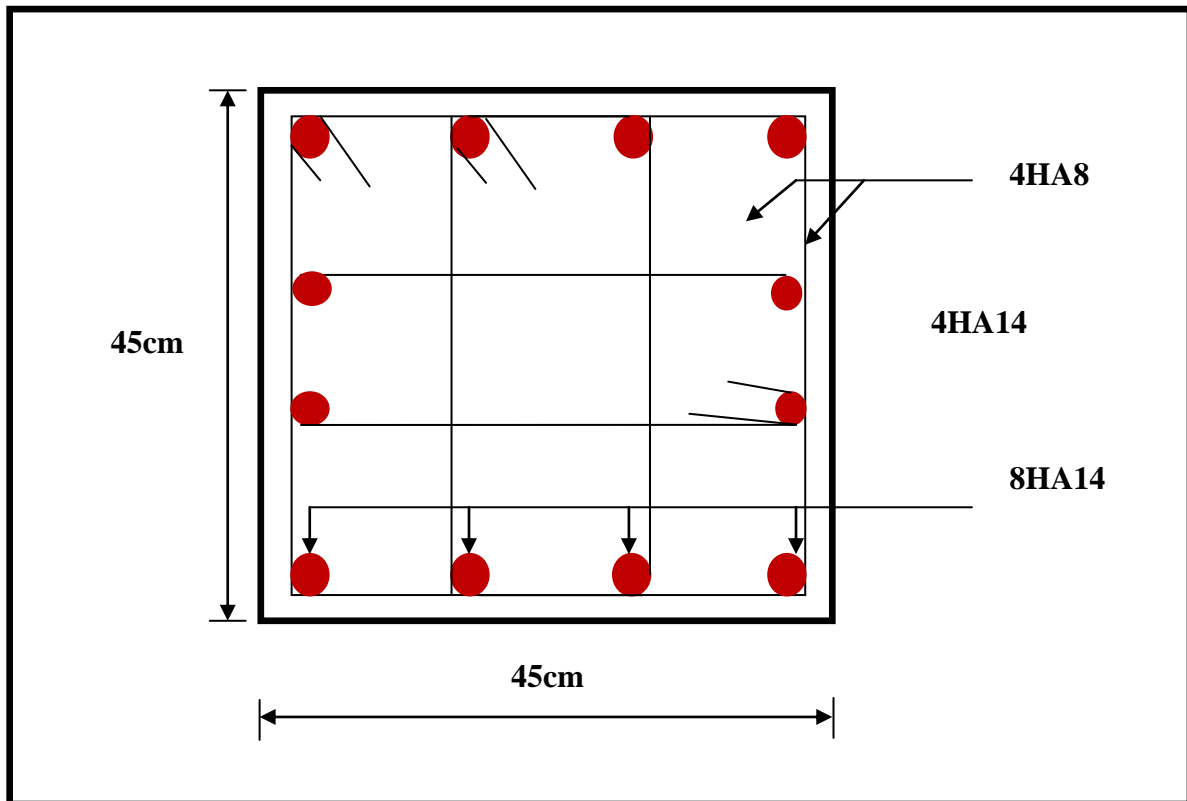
Ferrailage Poteau 40 × 40
